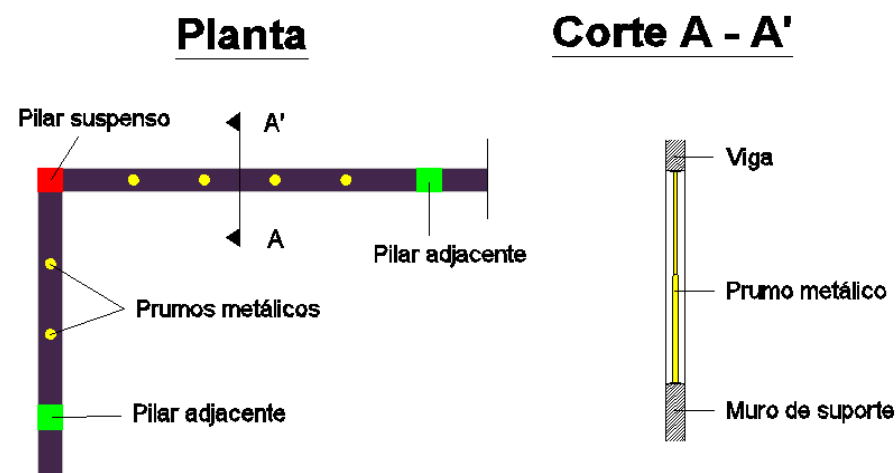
Escoramento da estrutura na zona do pilar suspenso
